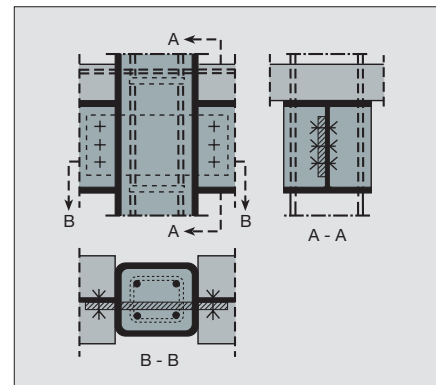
Anschluss an betongefüllte Hohlprofile mit durchgesteckten Laschen
